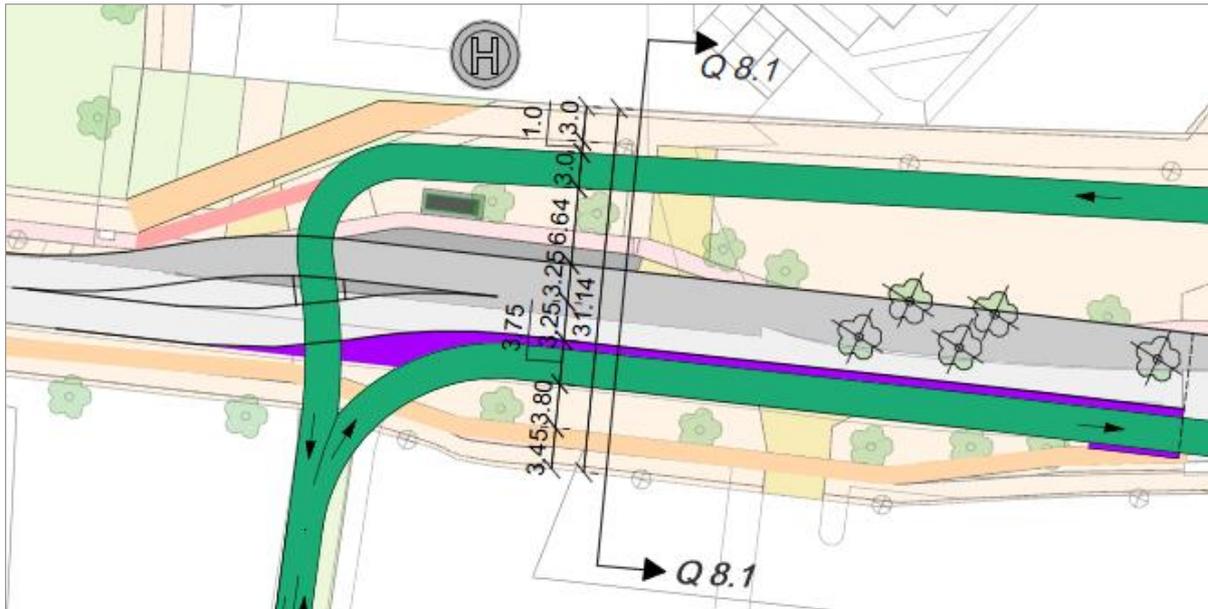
Falkenseer Chaussee Übergang Zweirichtungsradweg zu Einrichtungsradwegen
